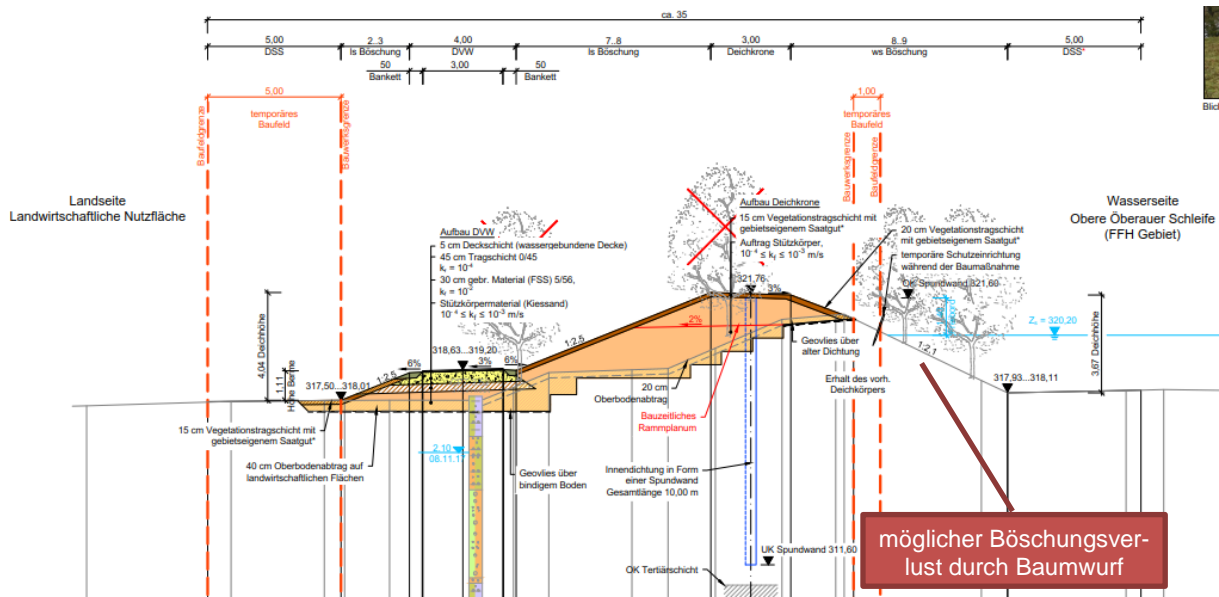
Deichabschnitt 1, Sonderprofil 3 (aus Plan 04-04-04, Blatt 8/8)
